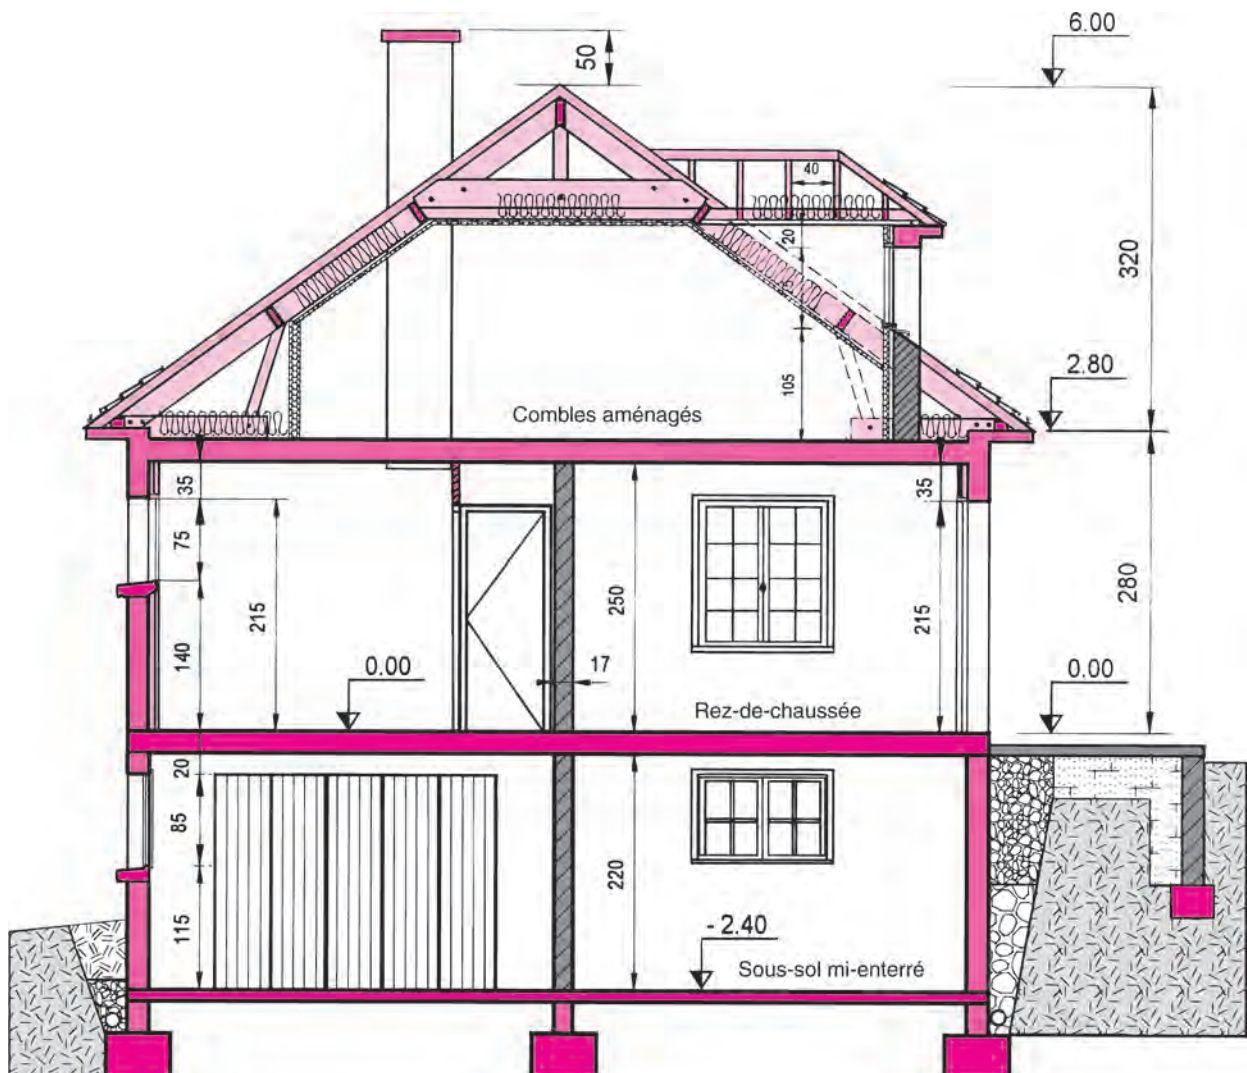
Coupe transversale sur la structure porteuse du pavillon
